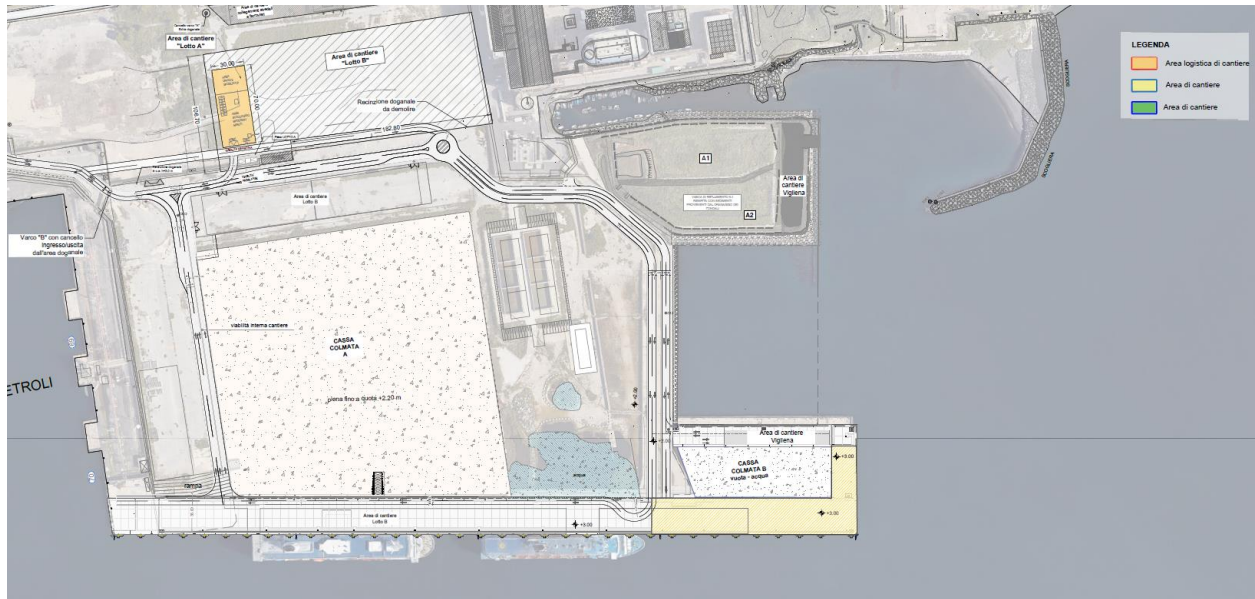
Planimetria di ubicazione dell'area logistica di cantiere
